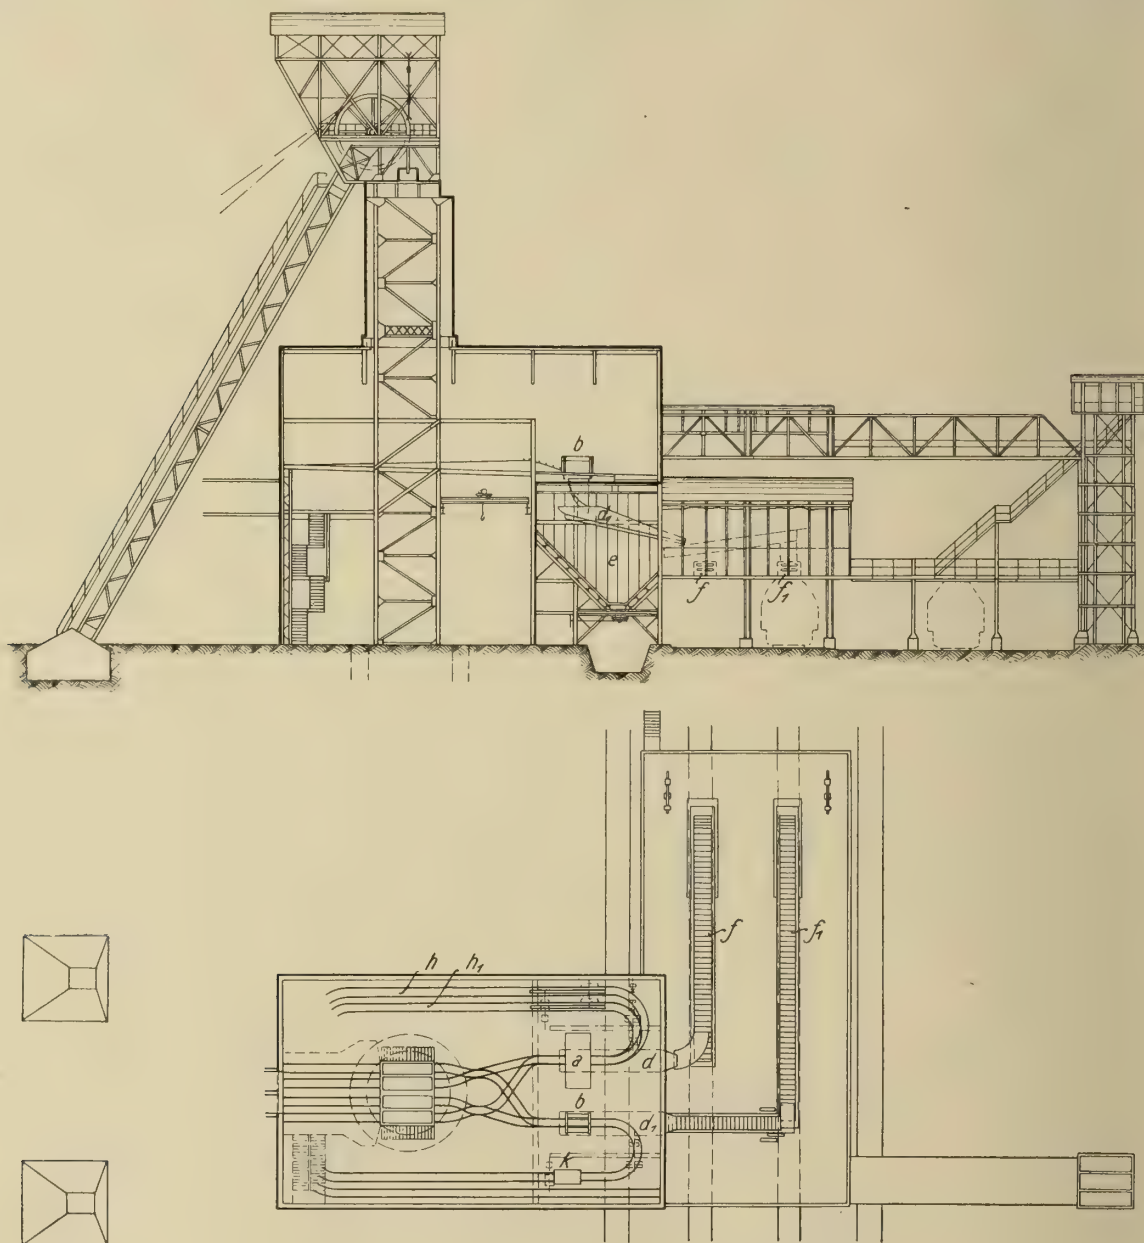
Ansicht und Grundriß des Wetterschachtgebäudes.
